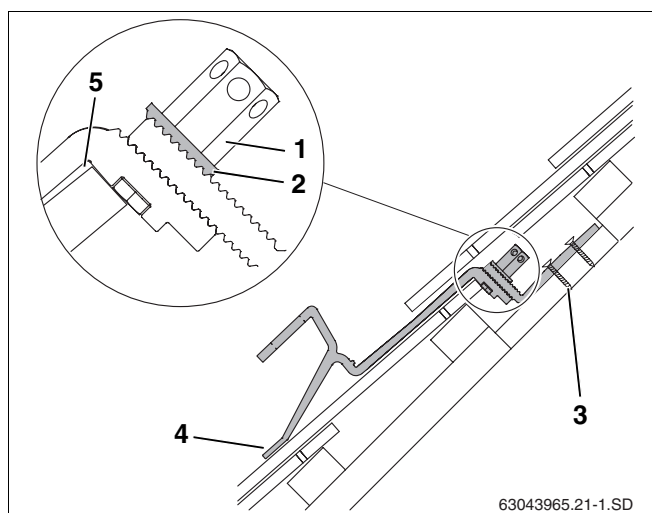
Gancho para telhados instalado. Apresentação de secção com parte inferior do gancho para telhados encurtada.
